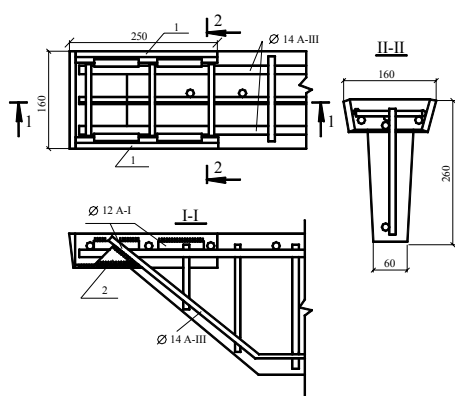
Армирование опорного узла прогона ПЖТ 6-500:
